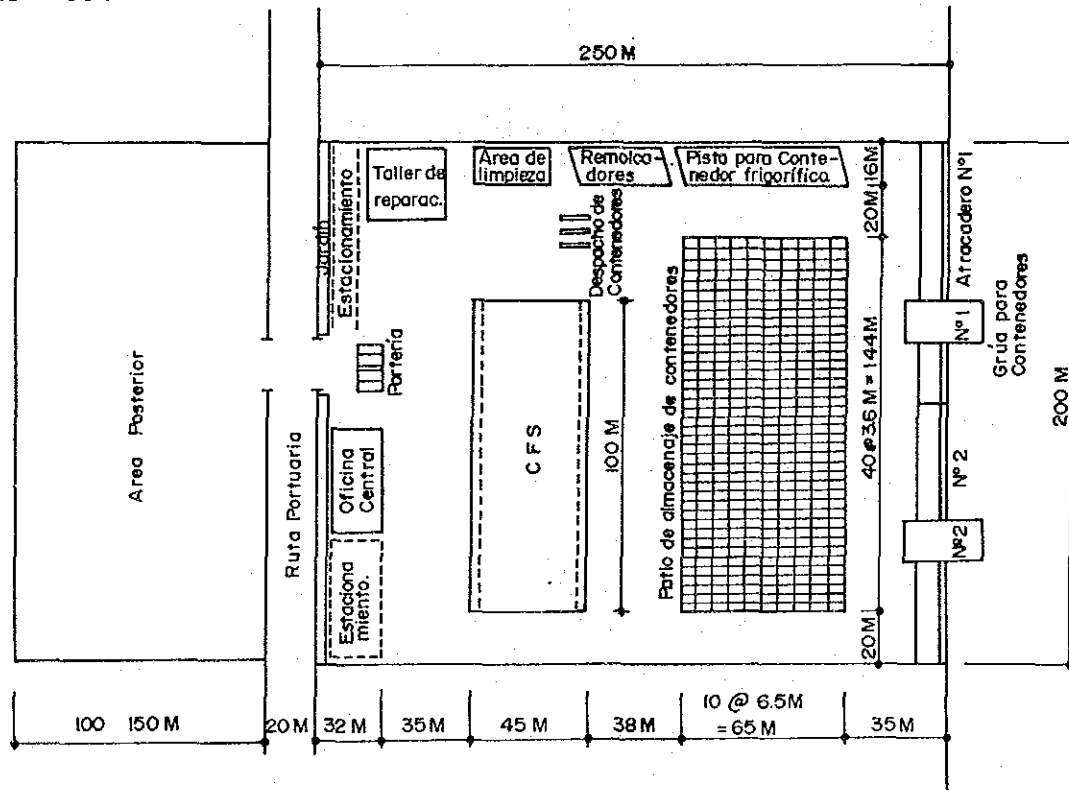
PLAN DE EQUIPAMIENTO DE LAS INSTALACIONES DE LA TERMINAL DE CONTENEDORES
